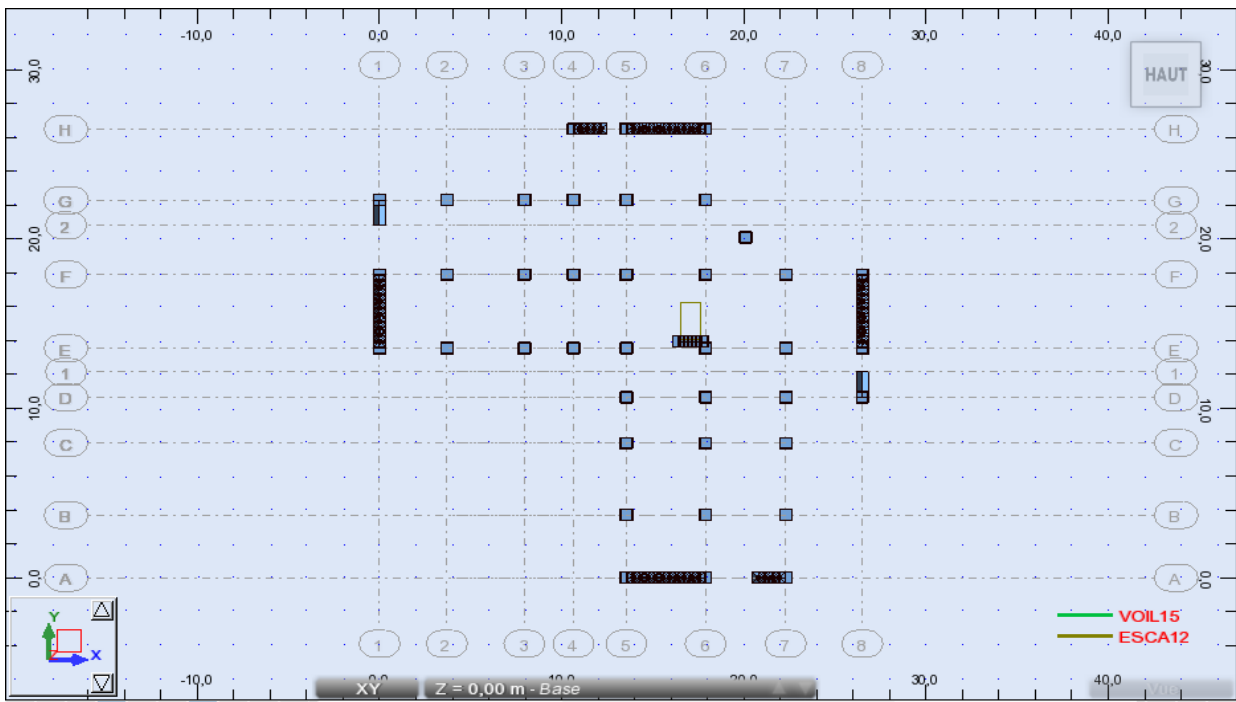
La 2ème disposition des murs voiles et poteaux
